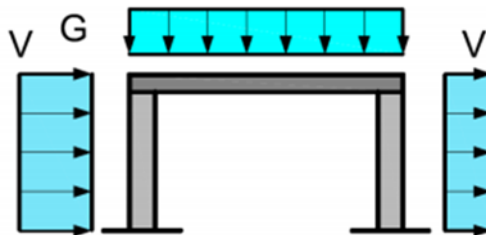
cargas variables. Fuente: asignatura, estructuras metálicas
